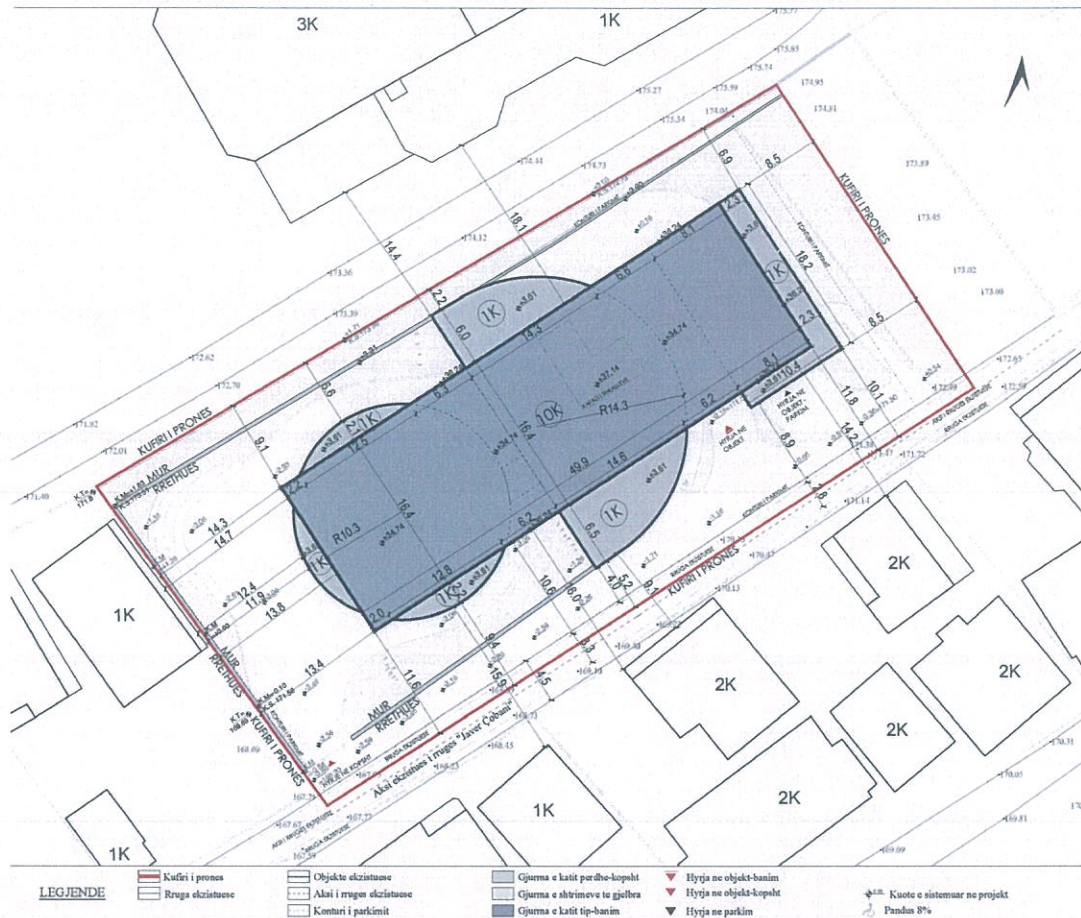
Planvendosje e objektit dhe sistemeve te propozuara
